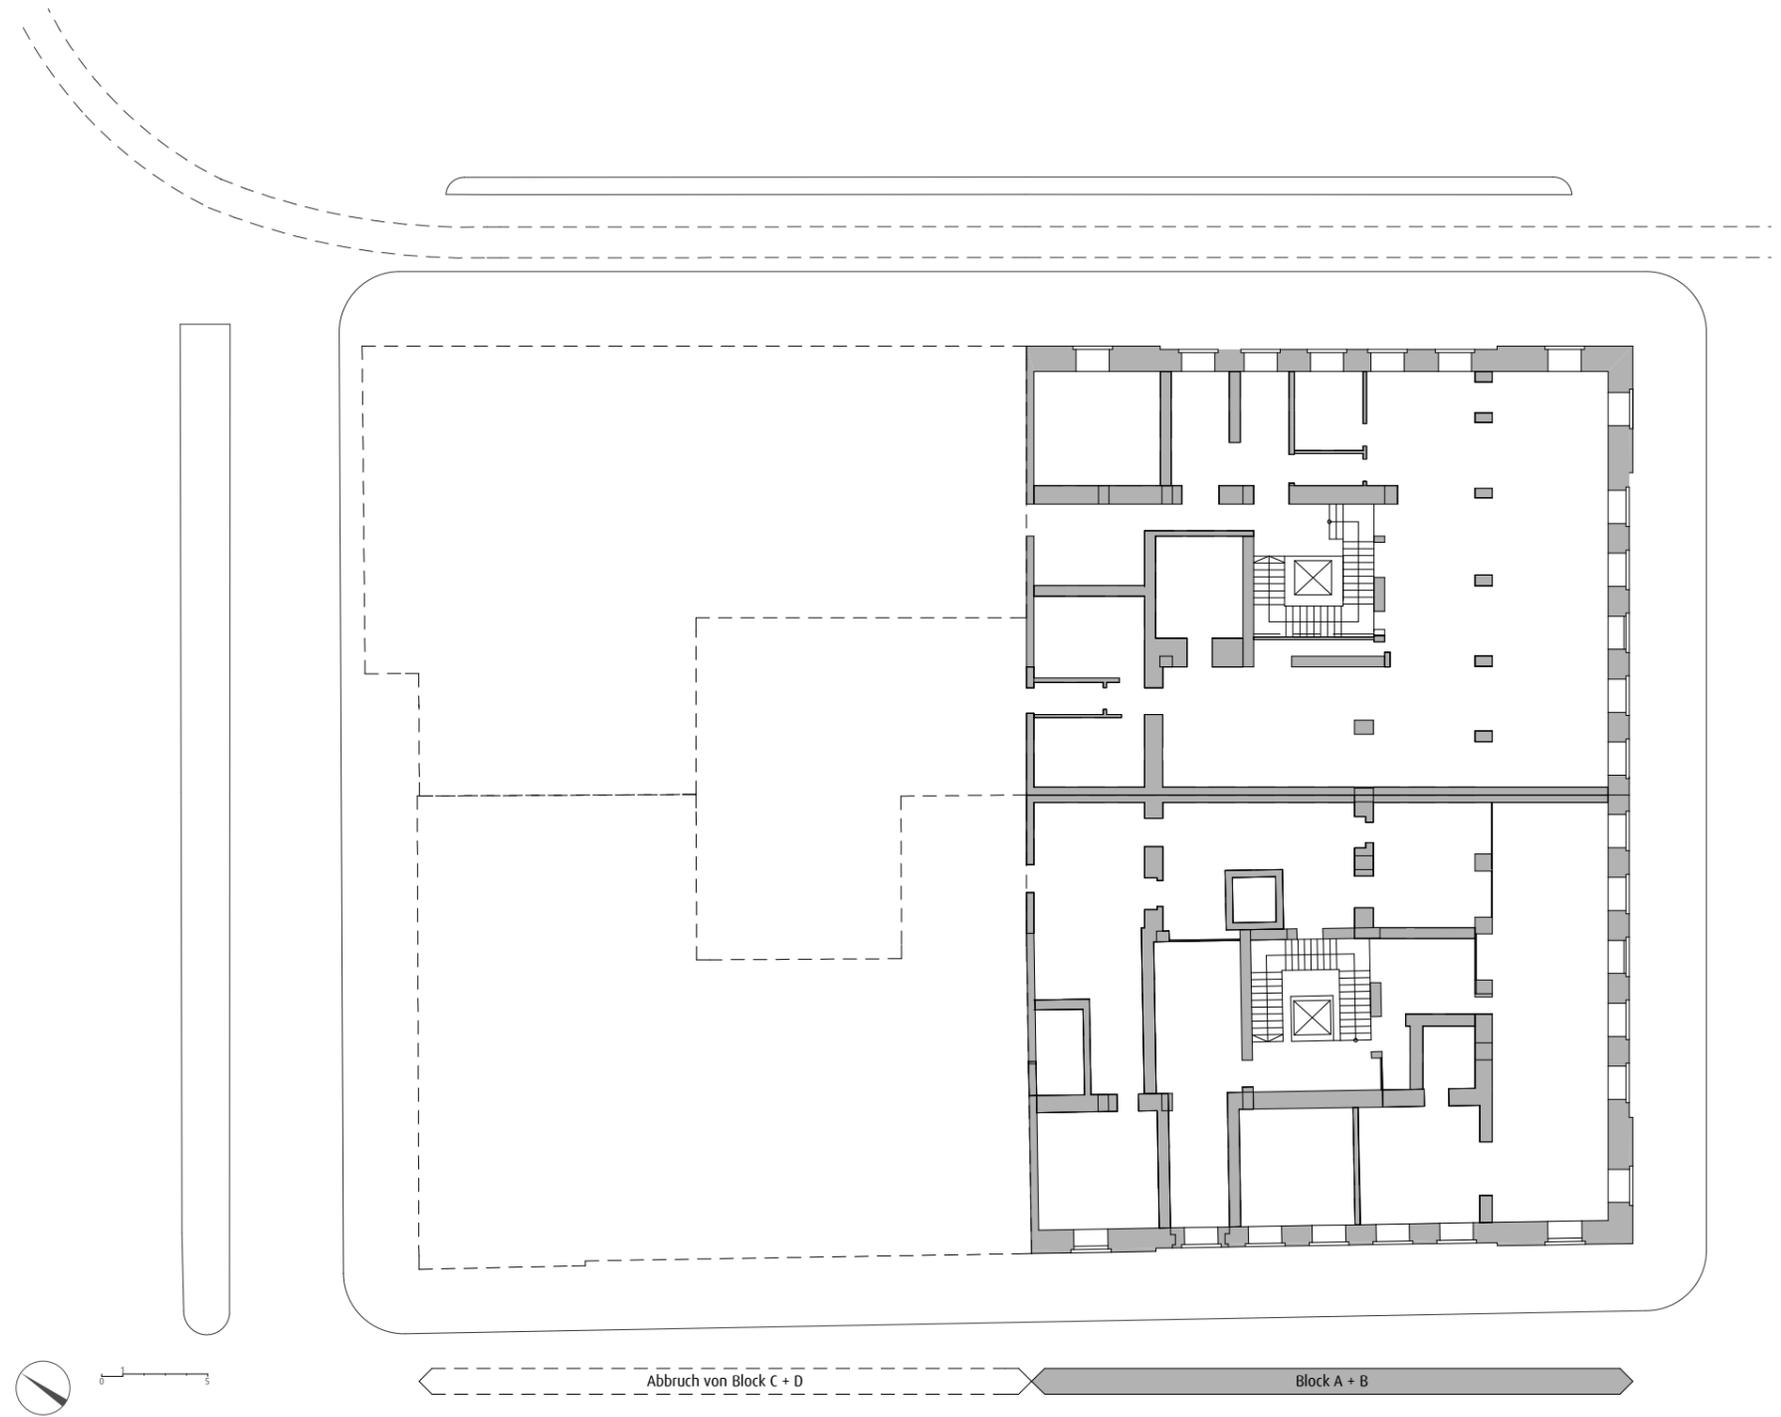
Grundriss Regelgeschoss, M 1:333
